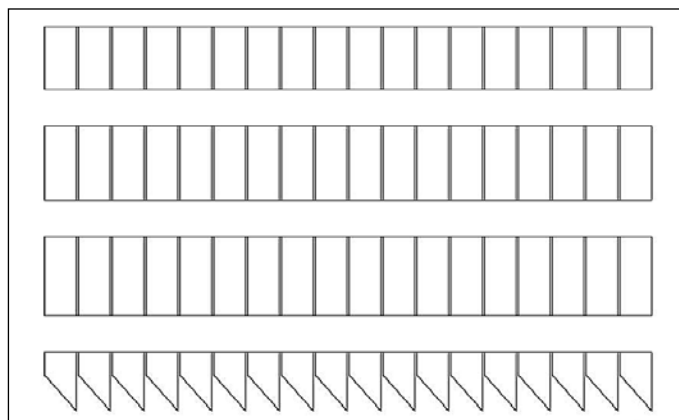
Schéma d'une palissade verticale avec renforcement horizontal.
